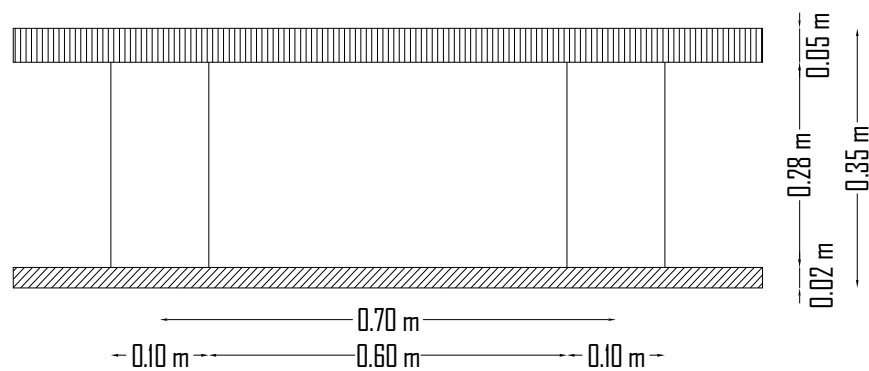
Secciones en planta de columnas, vigas, viguetas entre piso piso uno bloque dos
